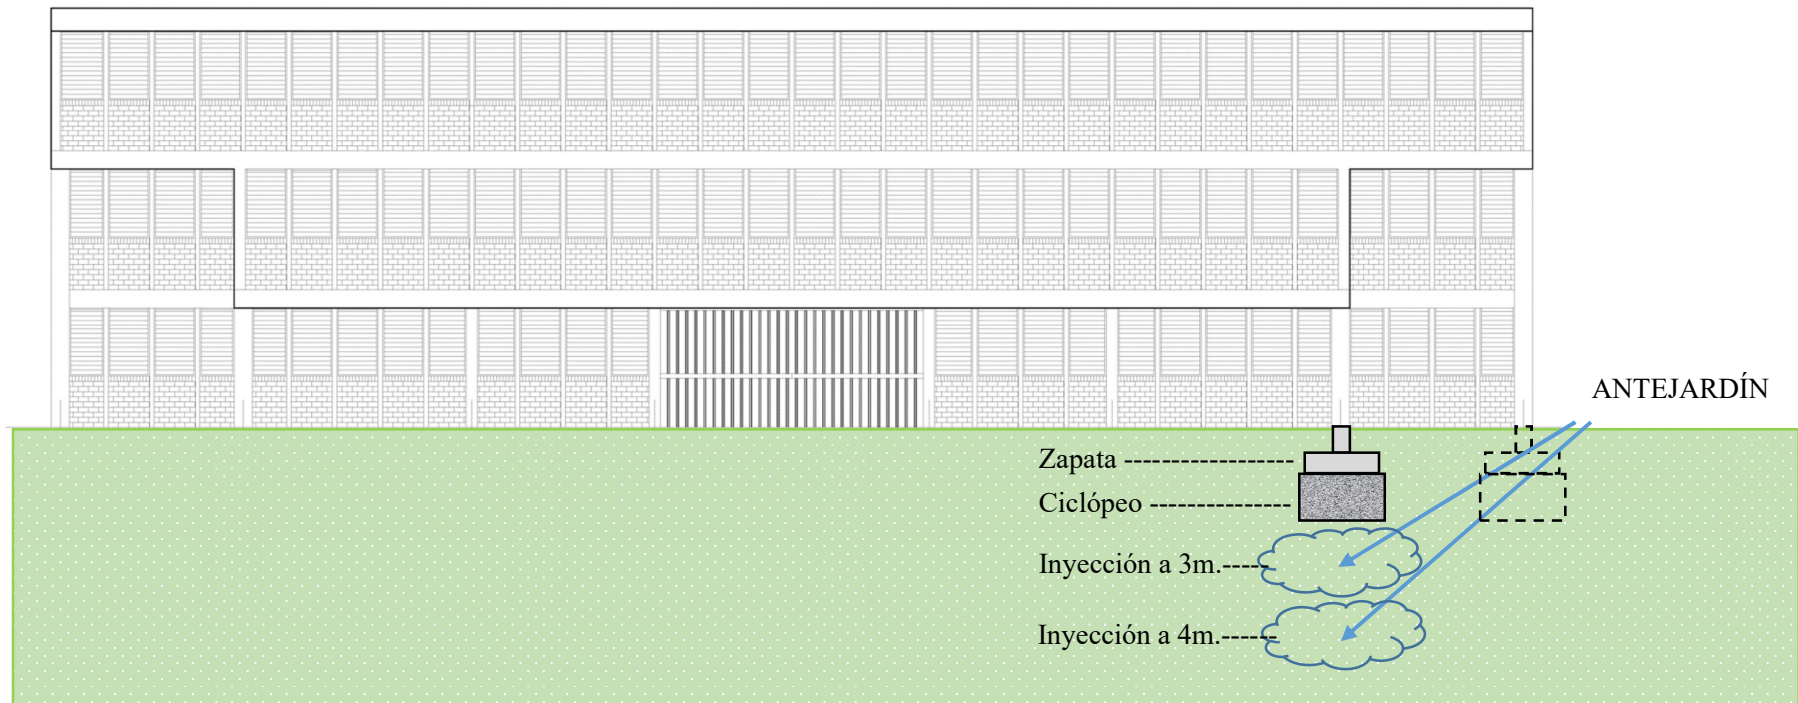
Esquema en corte de las inyecciones de lechada desde el antejardín hasta la cimentación afectada.
